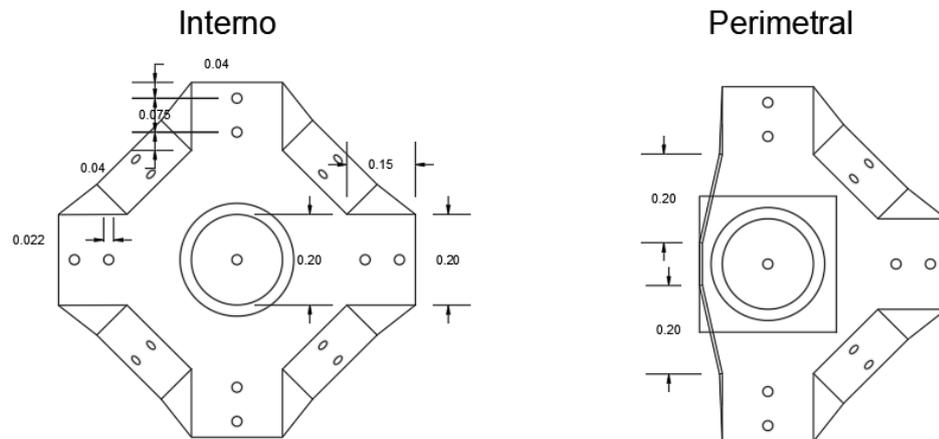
Dimensiones de los elementos especiales. Fuente: propia.
